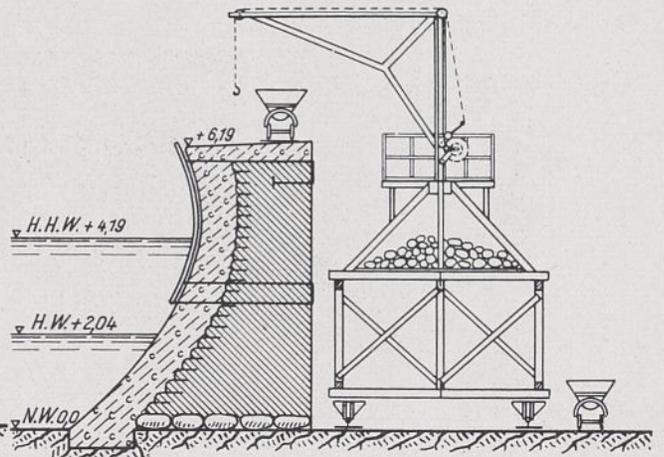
Querschnitt des Baugerüsts der Schutzmauer nach Brennecke.
